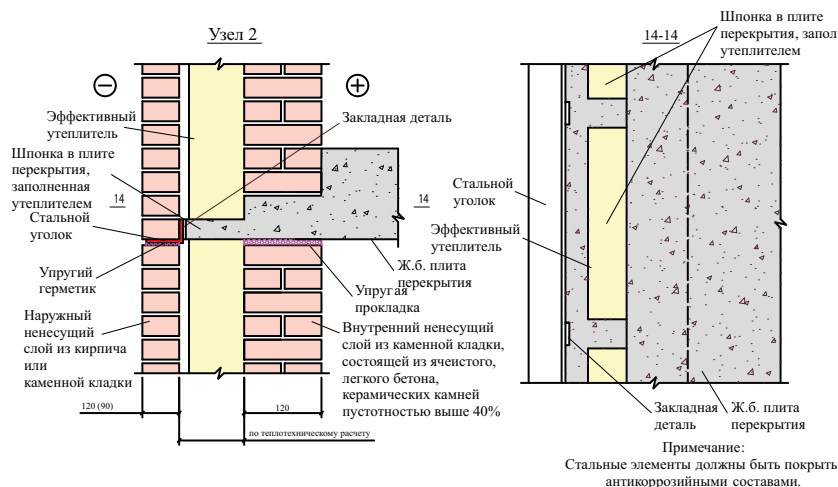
б. Наружная стена (тип ГН-1) для зданий высотой 1-30 этажей с несущим наружным слоем из кирпича, керамических или силикатных камней толщиной 12 см, устанавливаемым на стальной уголок и несущим внутренним слоем, устанавливаемым на перекрытие (ГН-1). Узел 2, сечение 14-14
